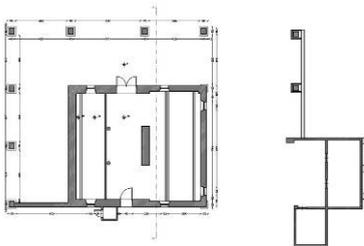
pianta piano terra stalla-fienile e protoservizi
